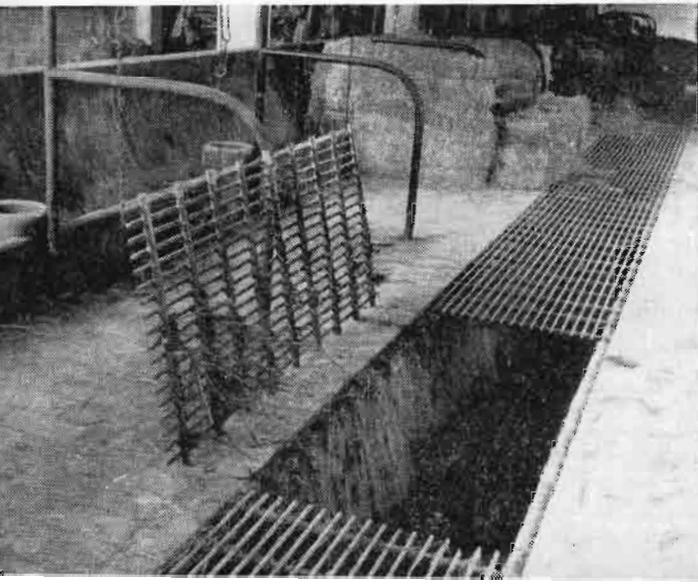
Establo de plaza corta para vacas, con canal emparrillado de parrillas metálicas.
